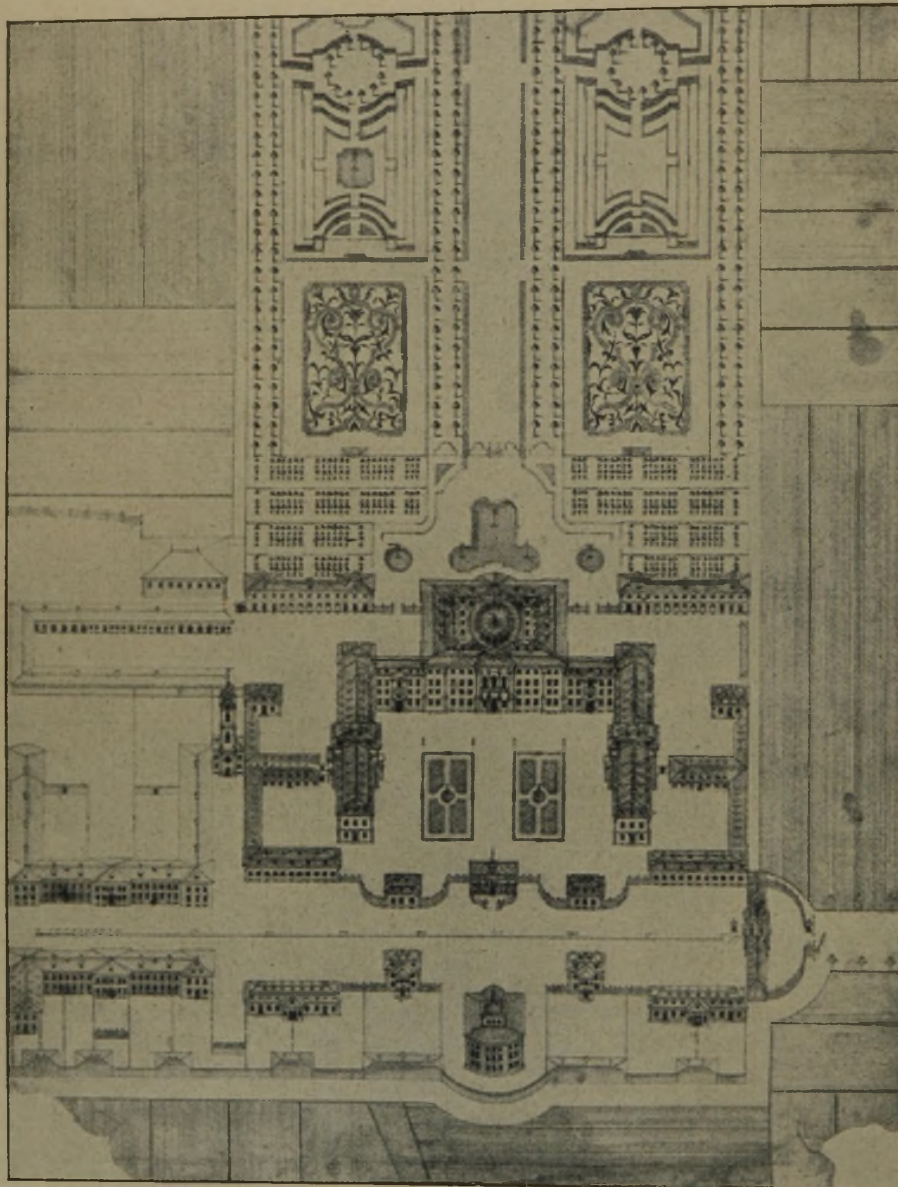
Grundriß des Schlosses. (Aus d. bad. General-Landesarchiv.)
